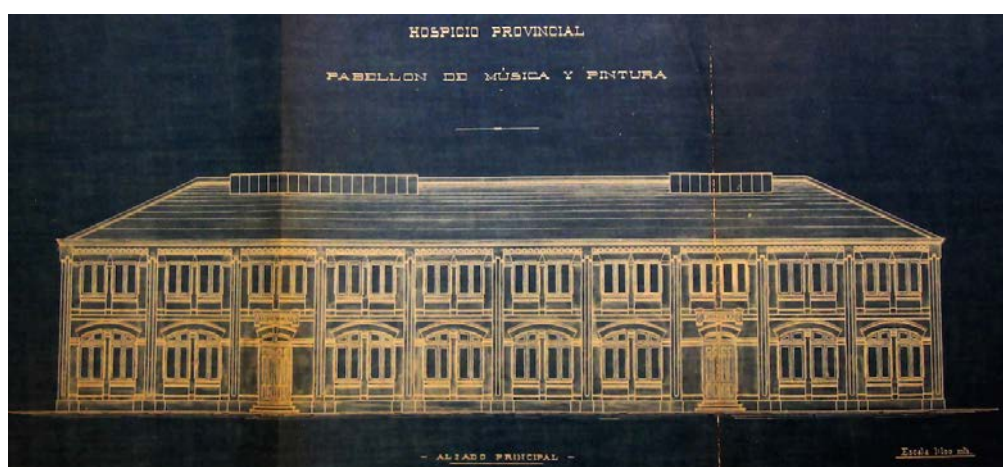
Alzado del pabellón de Música y Pintura (según Julio Bravo)
